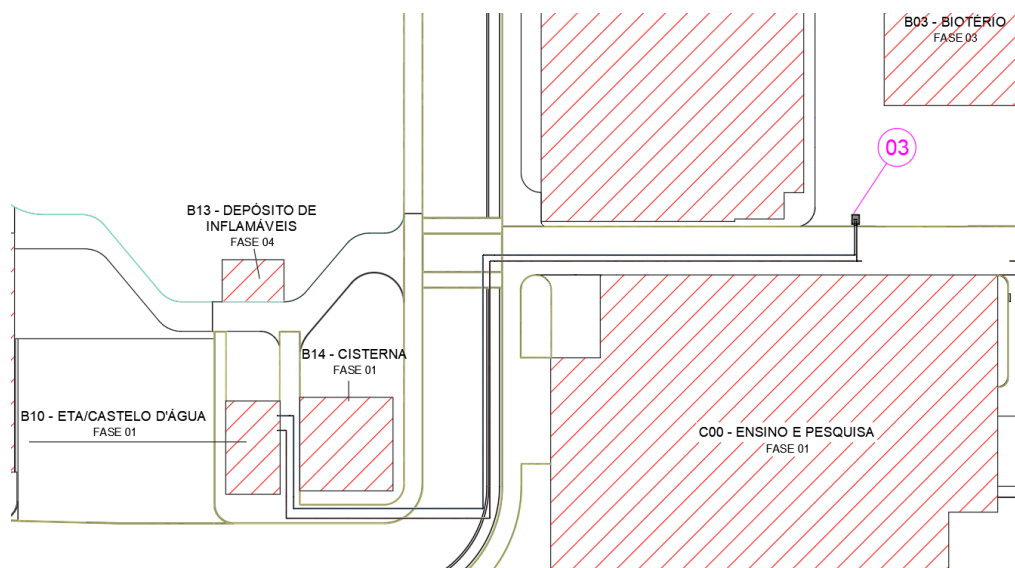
Planta trecho (Castelo d'água / Bloco B03)
